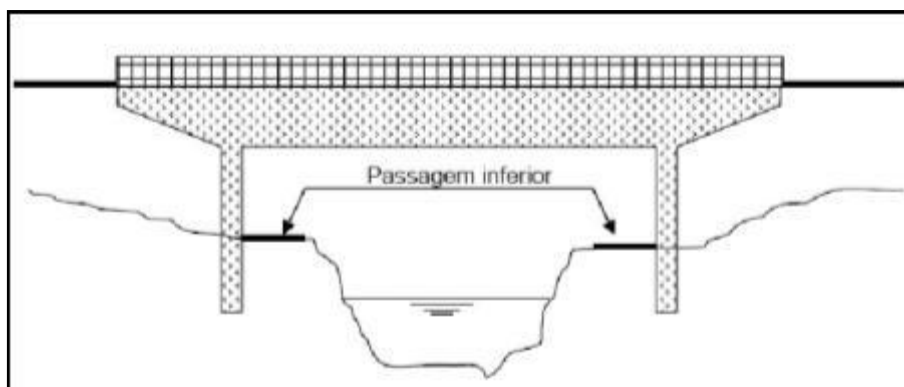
Detalhe do perfil longitudinal da ponte privilegiando a passagem da fauna terrestre
